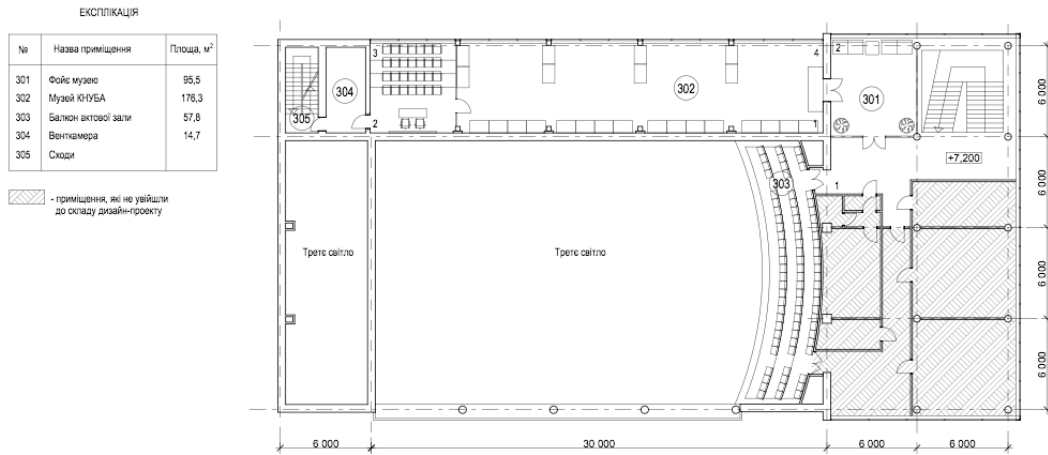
Кіно-концертна зала. Реконструкція. План 3-го поверху
